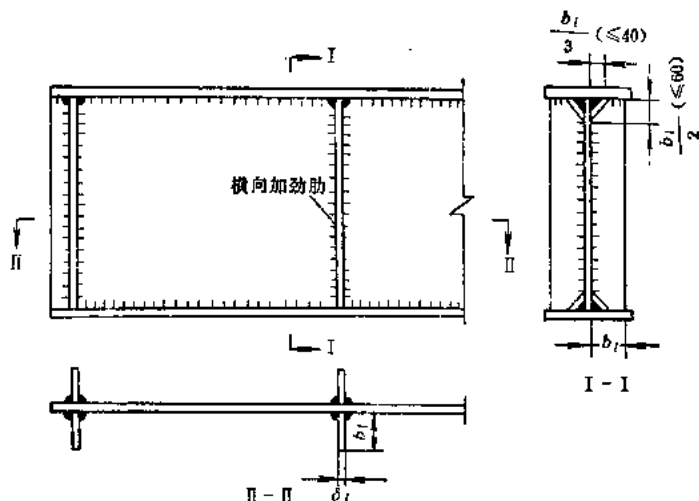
焊接梁横向加劲肋的构造与尺寸
